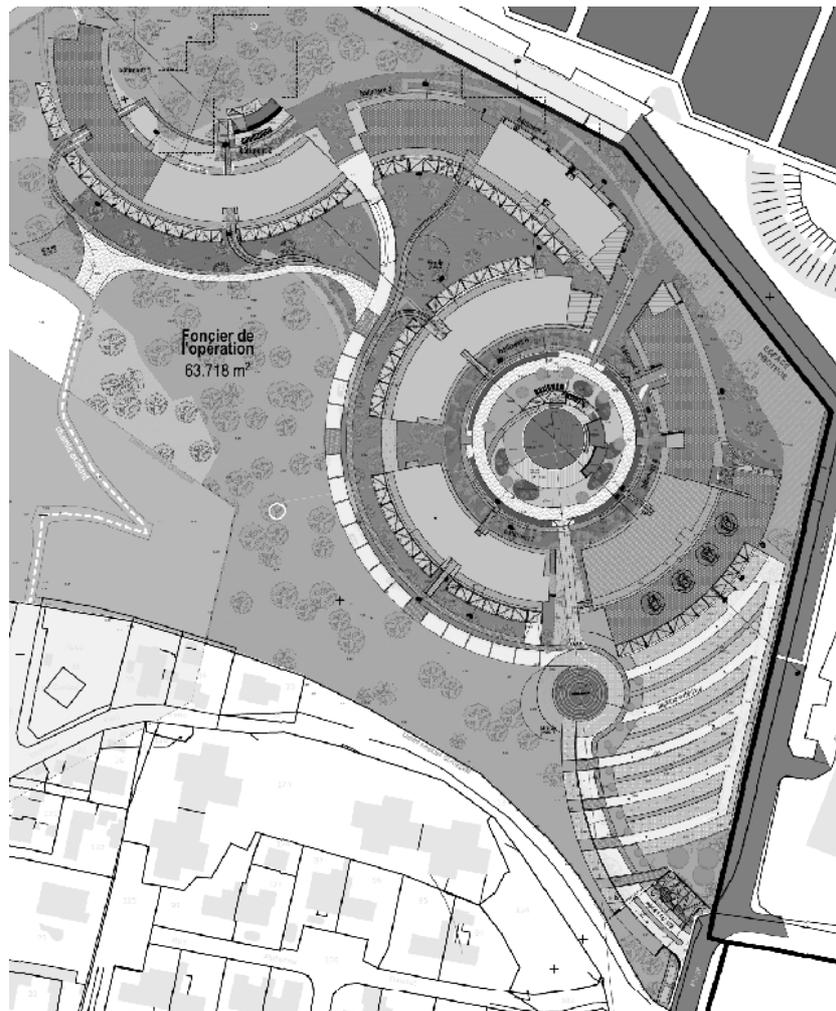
Extrait du plan de masse du projet (Source : architecte – Plan du 9 novembre 2022 - cf. Annexes)
